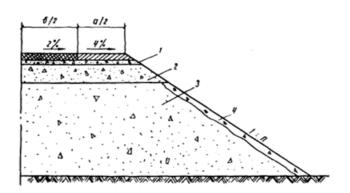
Конструкция насыпи из крупнообломочных грунтов
